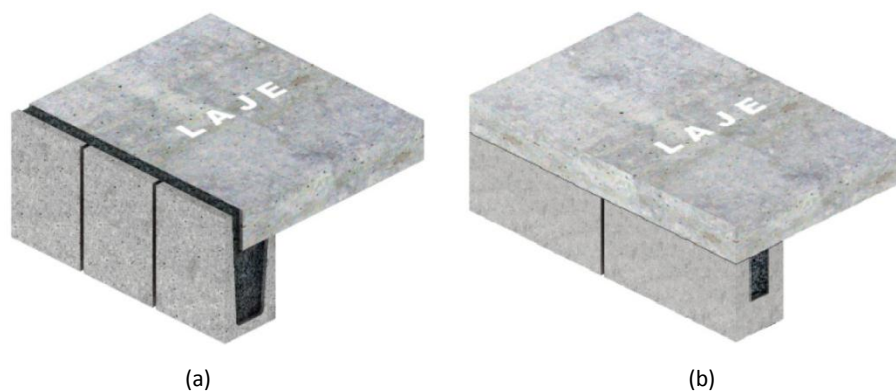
Pormenor da ligação da viga com a laje; (a) Com utilização do bloco canaleta tipo "J"; (b) Com utilização do bloco canaleta normal, (reproduzido de Junior, 2011).
